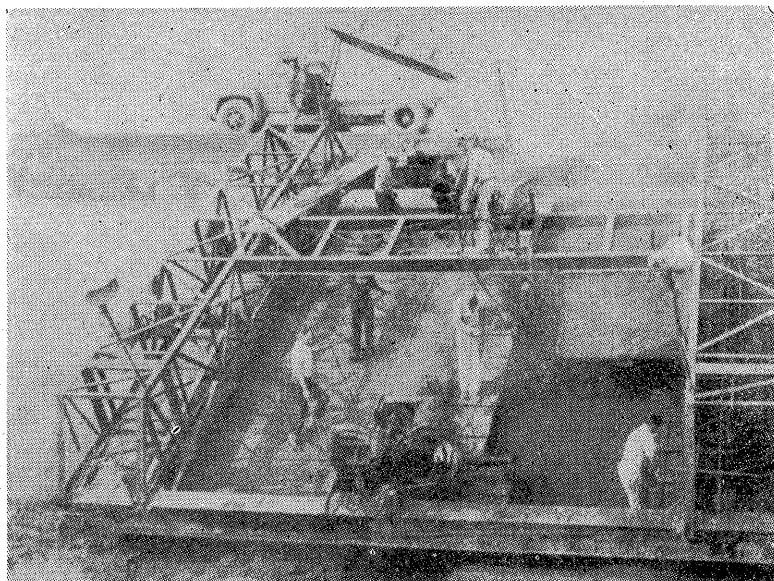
法面舗設機 (Slope paving machine) 堤防の縁端上のトラックから、オーガーにより合材を供給される
